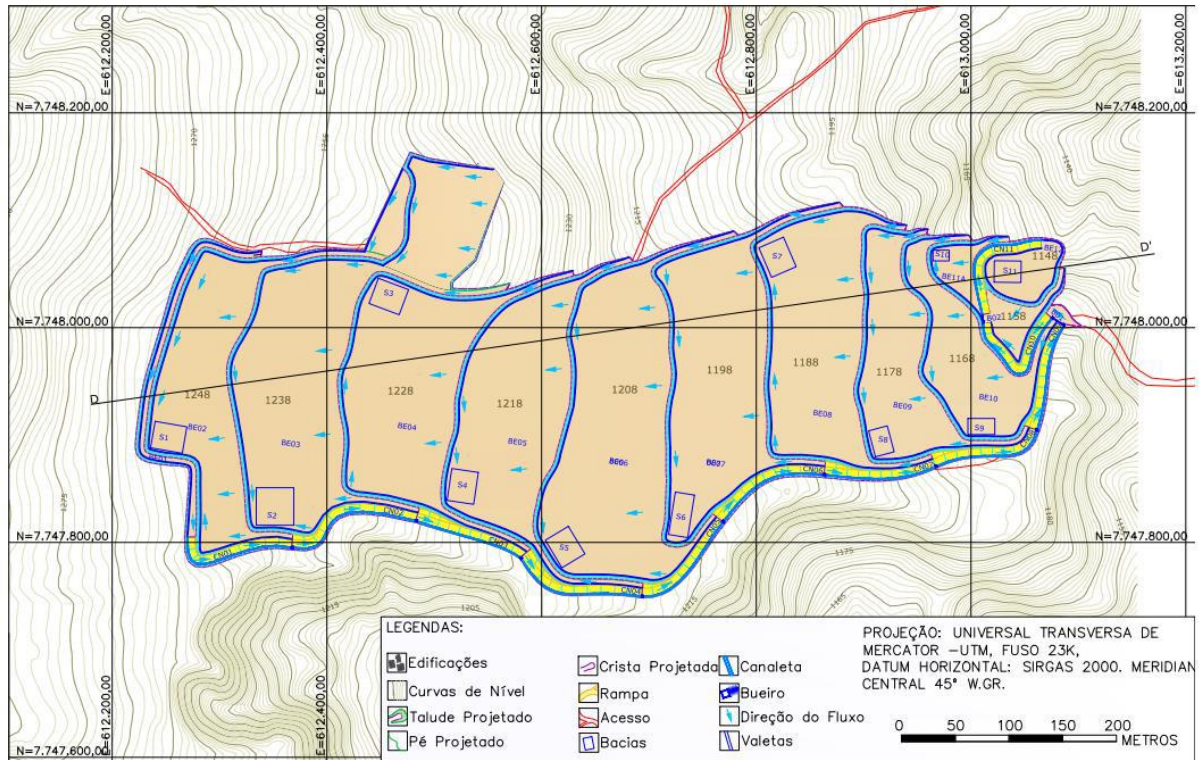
Layout do projeto de drenagem da Cava da Bauxita.
